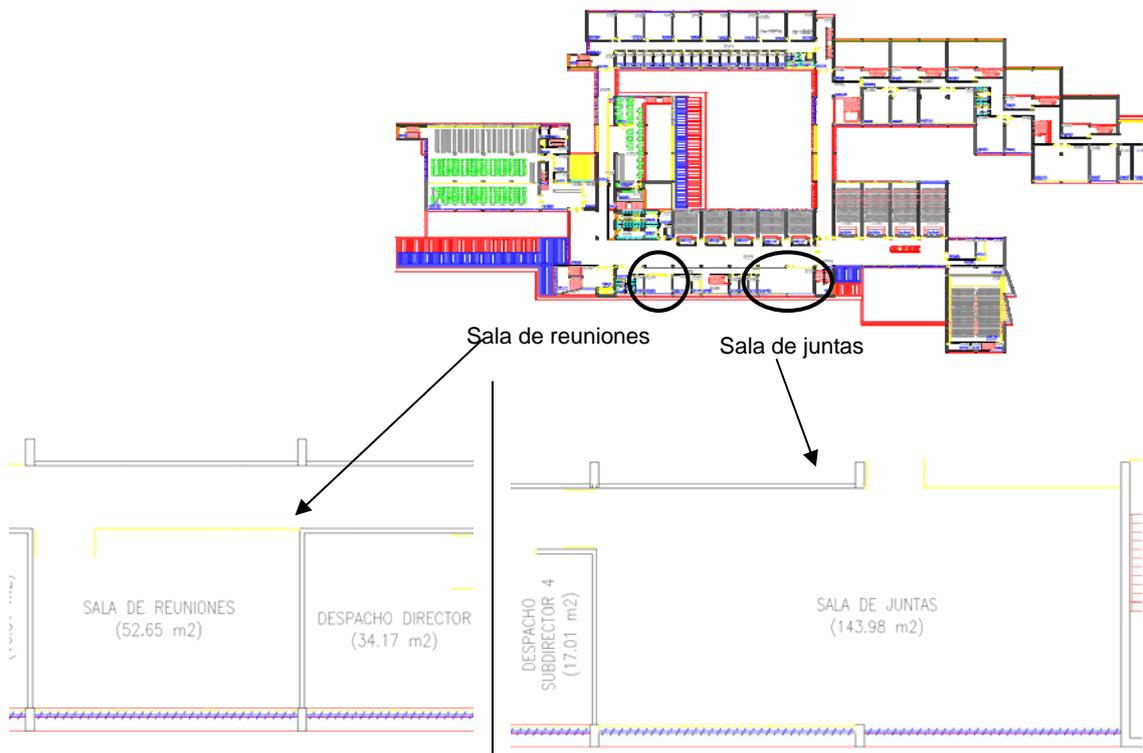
14. Localización y distribución de las Sala de Reuniones y de Juntas situadas en la primera planta
